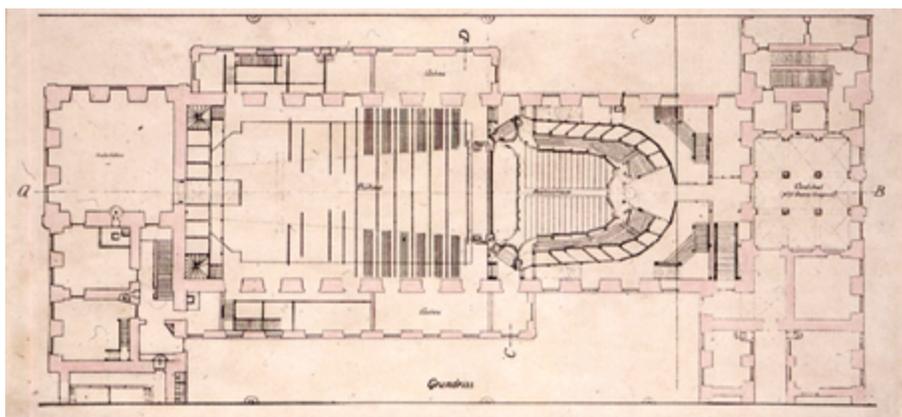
Das kurfürstliche Opernhaus im Mannheimer Schloss, Grundriss, o. J.
